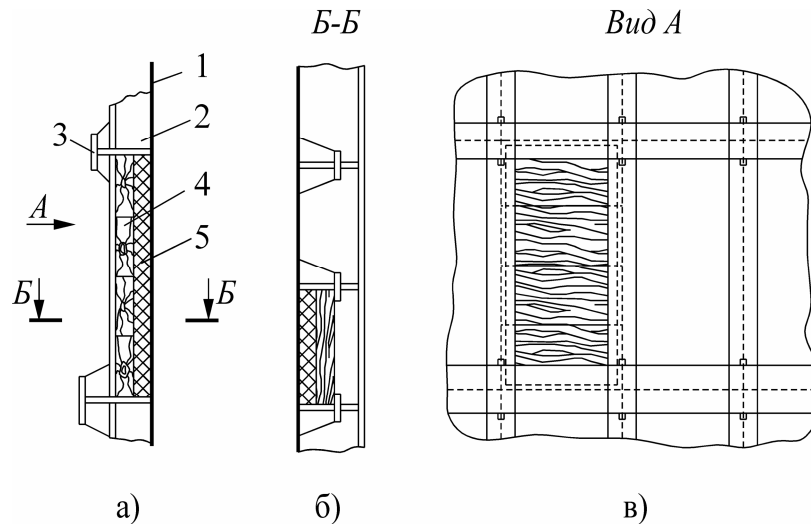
Схема модернизированного перекрытия: а) – общий вид бортового перекрытия; б) – разрез Б-Б; в) – вид А
